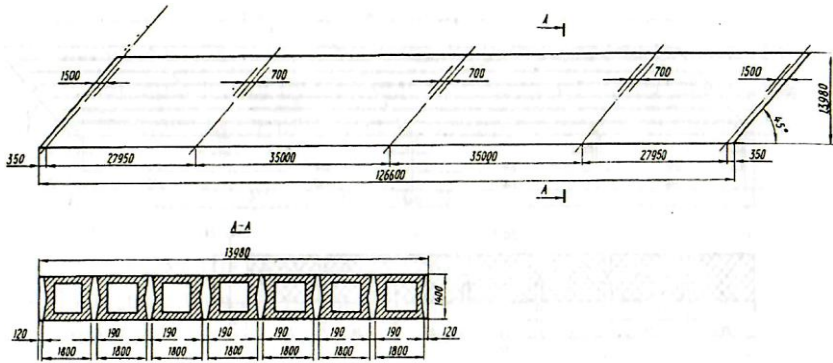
План і поперечний розріз чотирипрольотного нерозрізного косої шляхопроводу.
